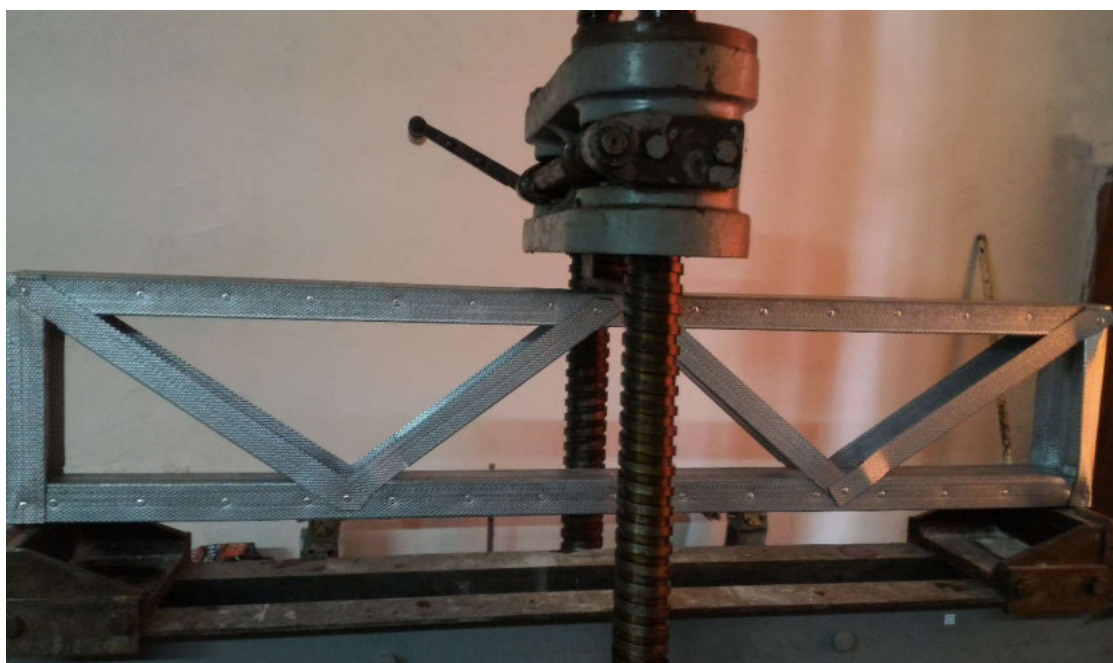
Випробування сталезалізобетонних ферм ПСБ150 на згин
